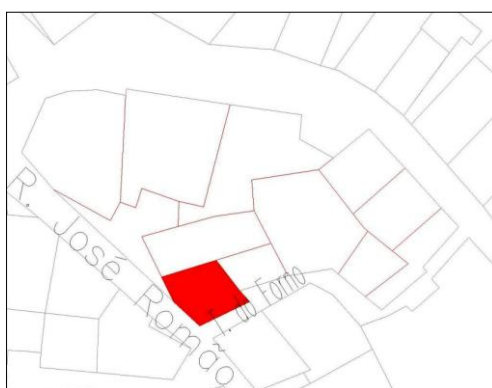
| Planta de localização - 2000 (Fonte: CMTN)
